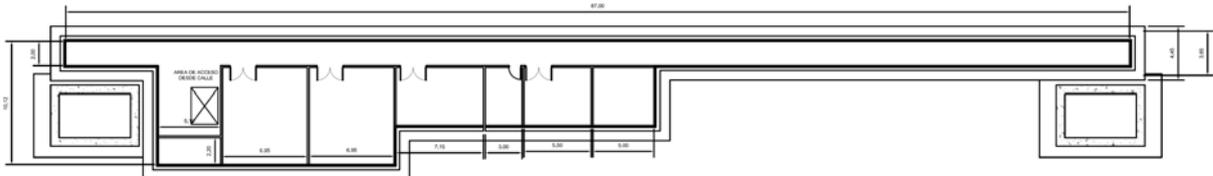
Planta nivel locales técnicos para estación tipo elevada
